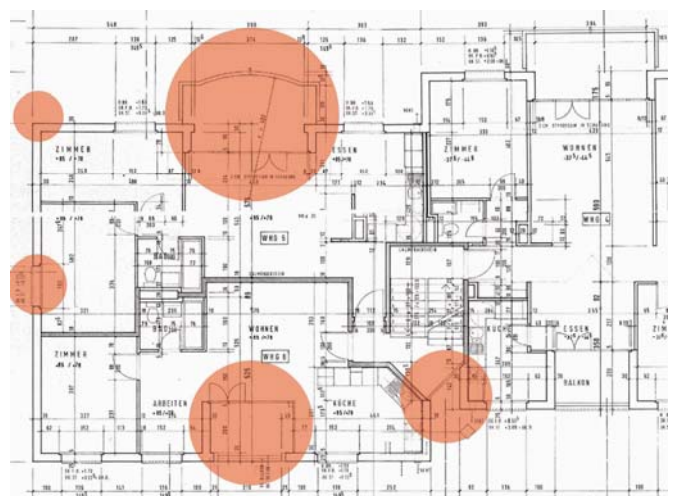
Typischer Geschossgrundriss (Quelle: Dransfeld)
